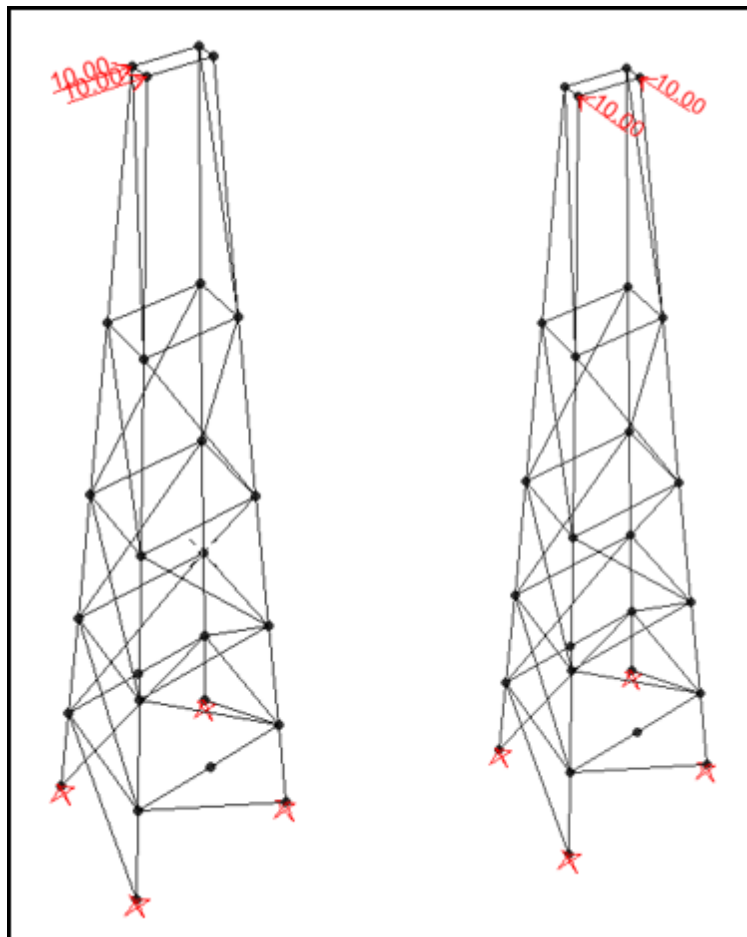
Carga unitaria para cálculo de rigidez en torre con columnas inclinadas. Fuente propia
